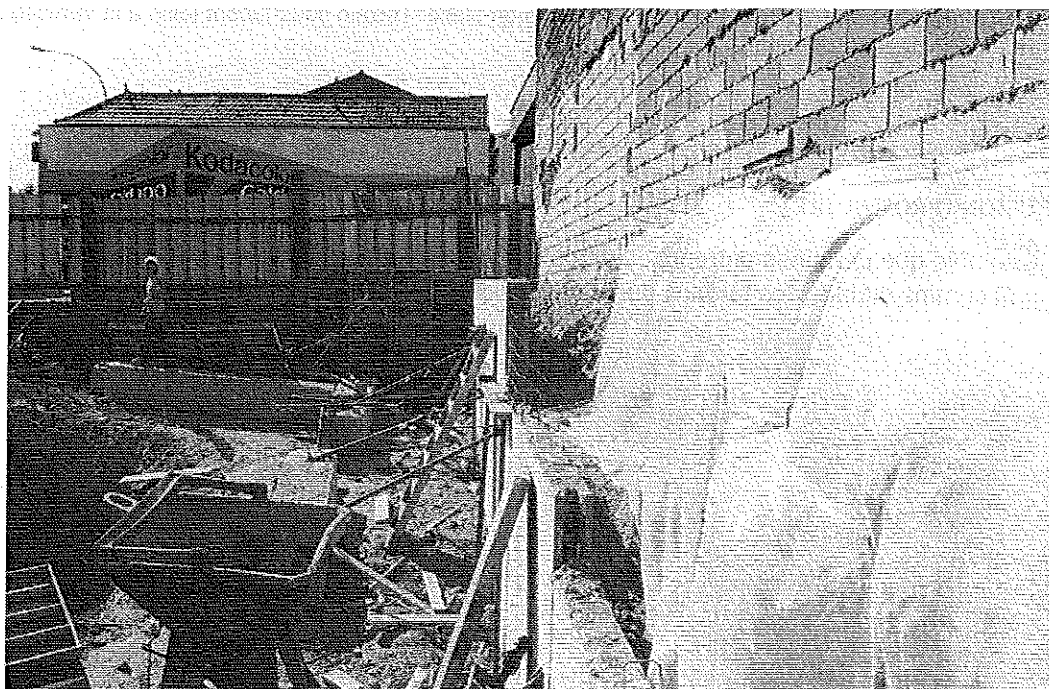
Détail about du mur côté rampe d'accès. © J. Putatti
